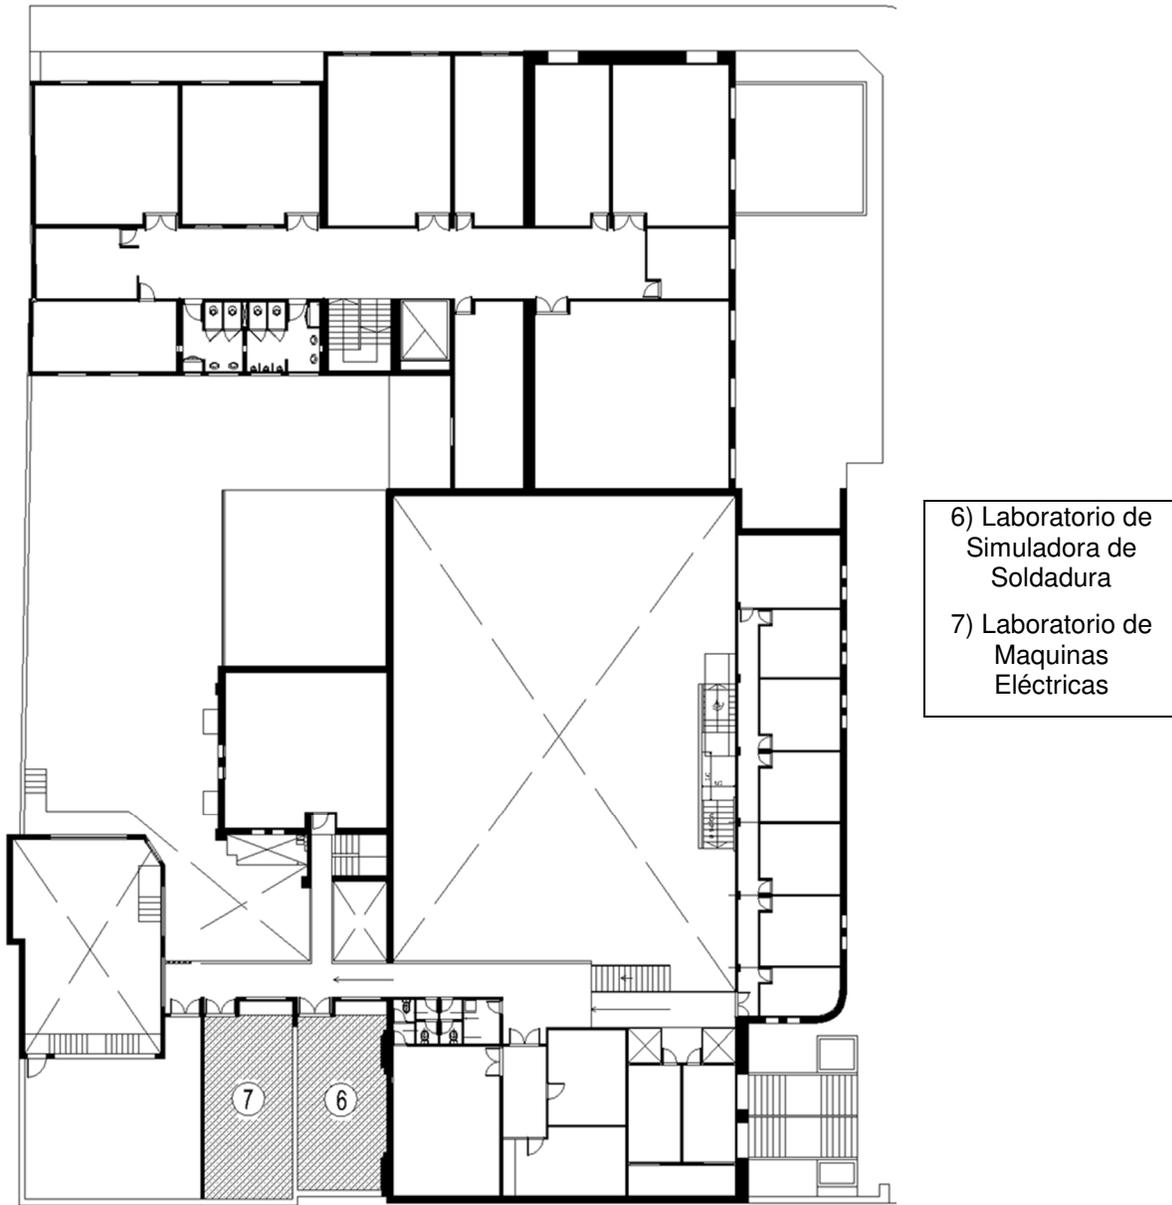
Croquis con ubicación de los laboratorios en Planta Alta. (FRCon)
